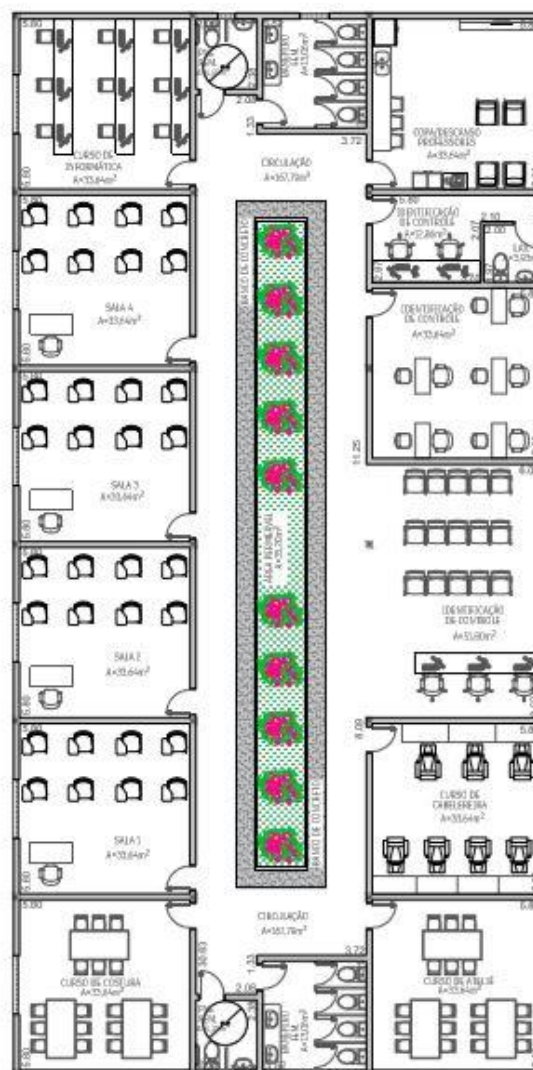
Planta Humanizada – Fonte: Acervo Próprio
